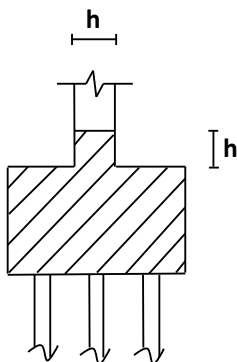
En las zapatas cimentadas sobre pilotes, las zonas de discontinuidad aparecen debido a los cambios de sección entre dicho elemento, la columna y los pilotes, teniendo en cuenta además las cargas fijas que se transmiten entre ellos. Por esta razón este elemento también comportará como una gran zona de discontinuidad (D).
